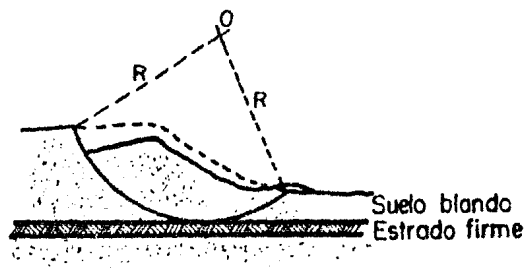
FALLAS ROTACIONALES. SECCIONES TÍPICAS
